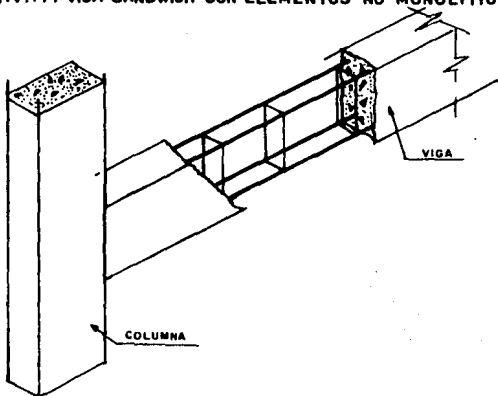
ACERO DE REFUERZO EN UNA VIGA SANDWICH
